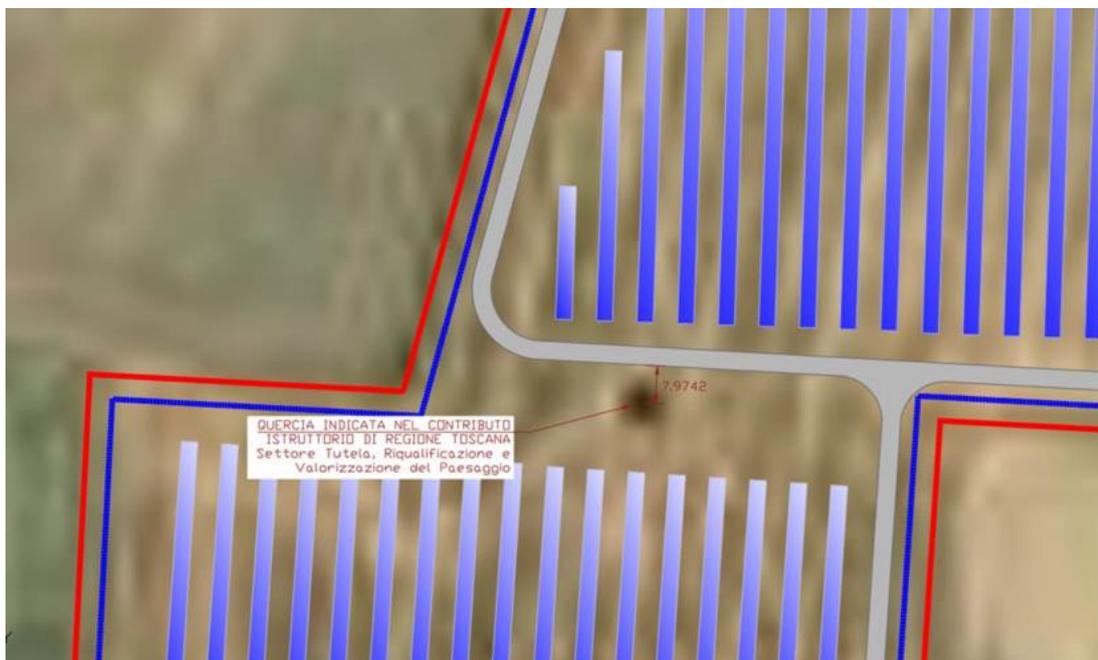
a Ubicazione quercia rispetto alle opere in progetto
